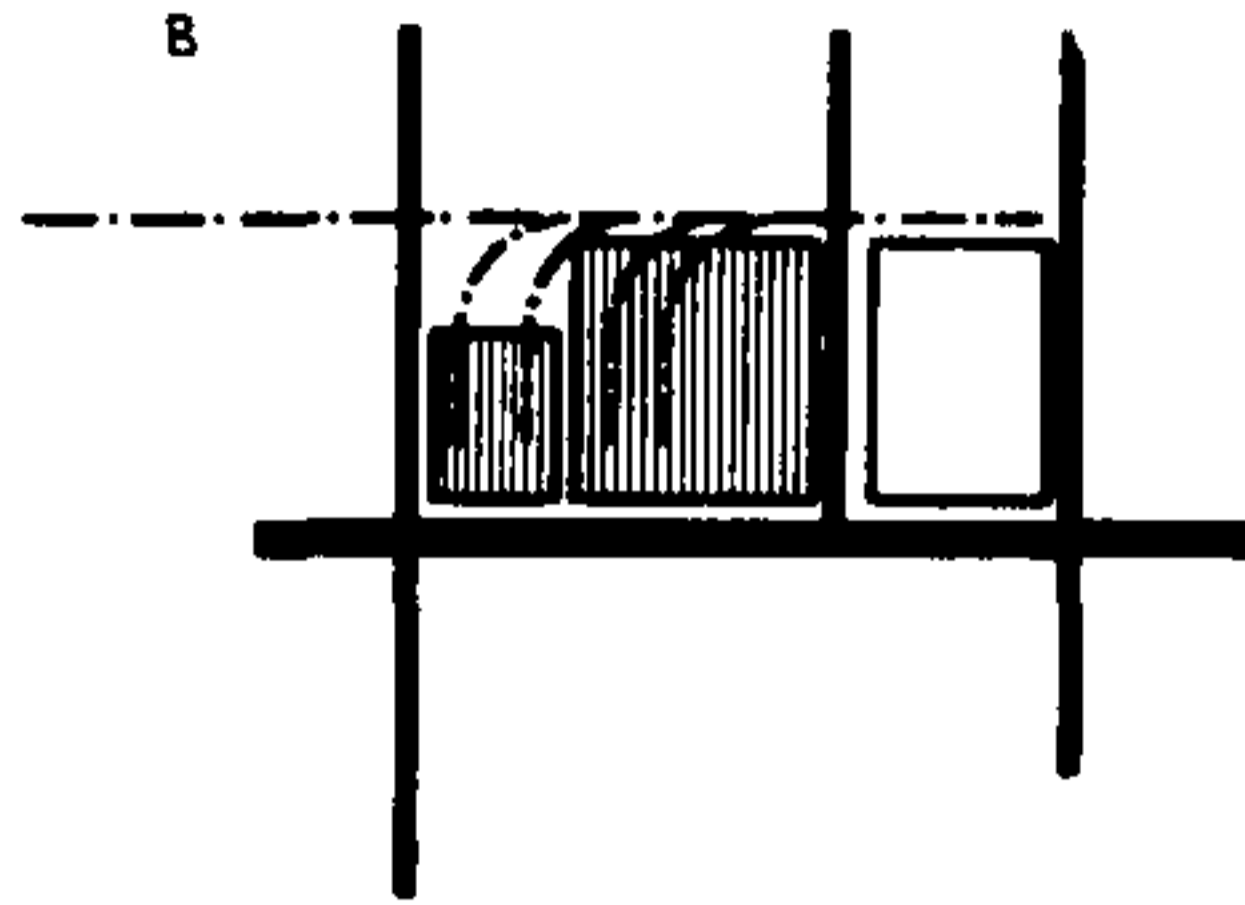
Формирование схем генеральных планов промышленно-коммунальных зон
